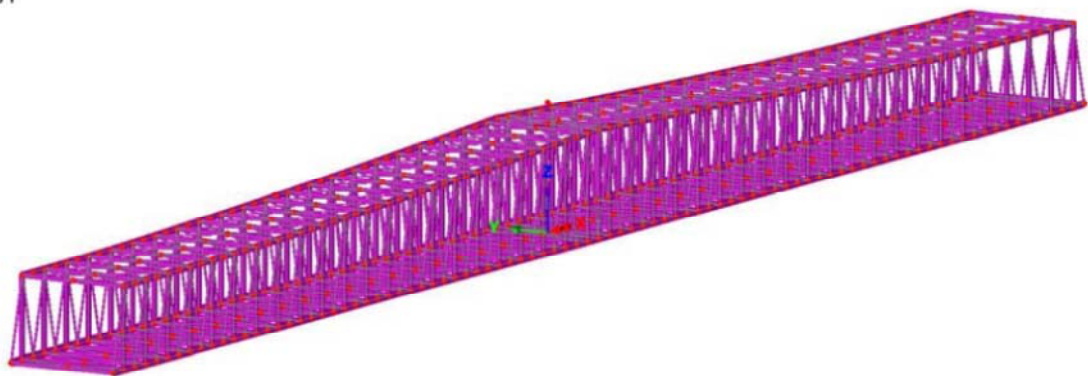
Studio soluzione alternativa: modello viadotto a travata reticolare Warren
